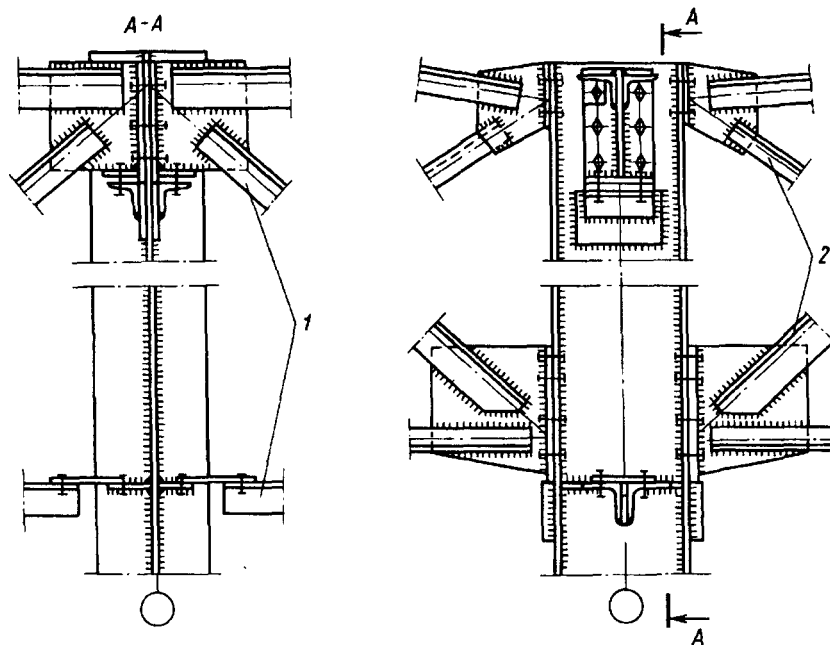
Узел опирания подстропильной фермы на колонну
